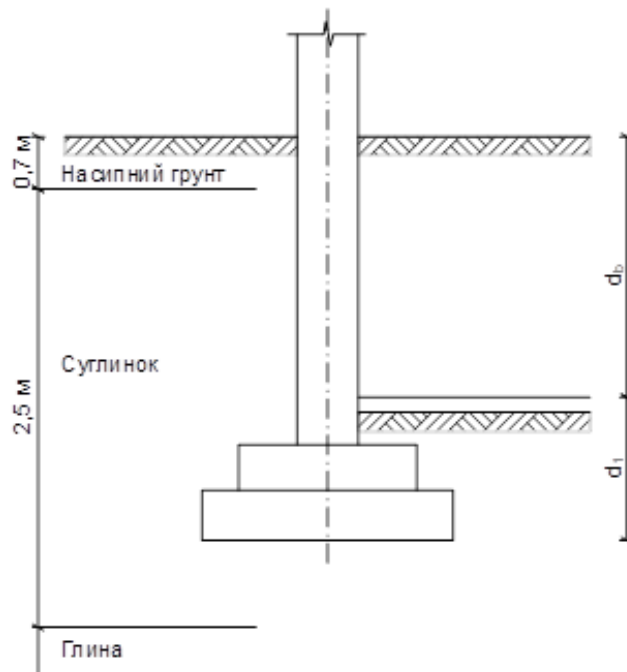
Схема розміщення фундаменту у ґрунті
